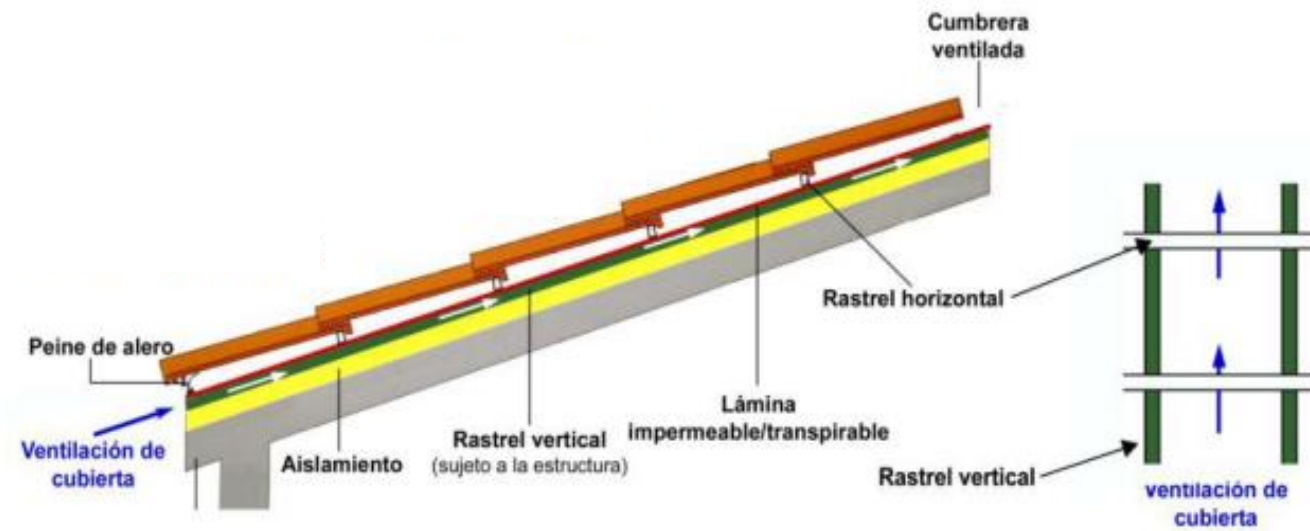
Acabado interior y exterior de cubierta: pino nacional y tejado ligero ventilado.
